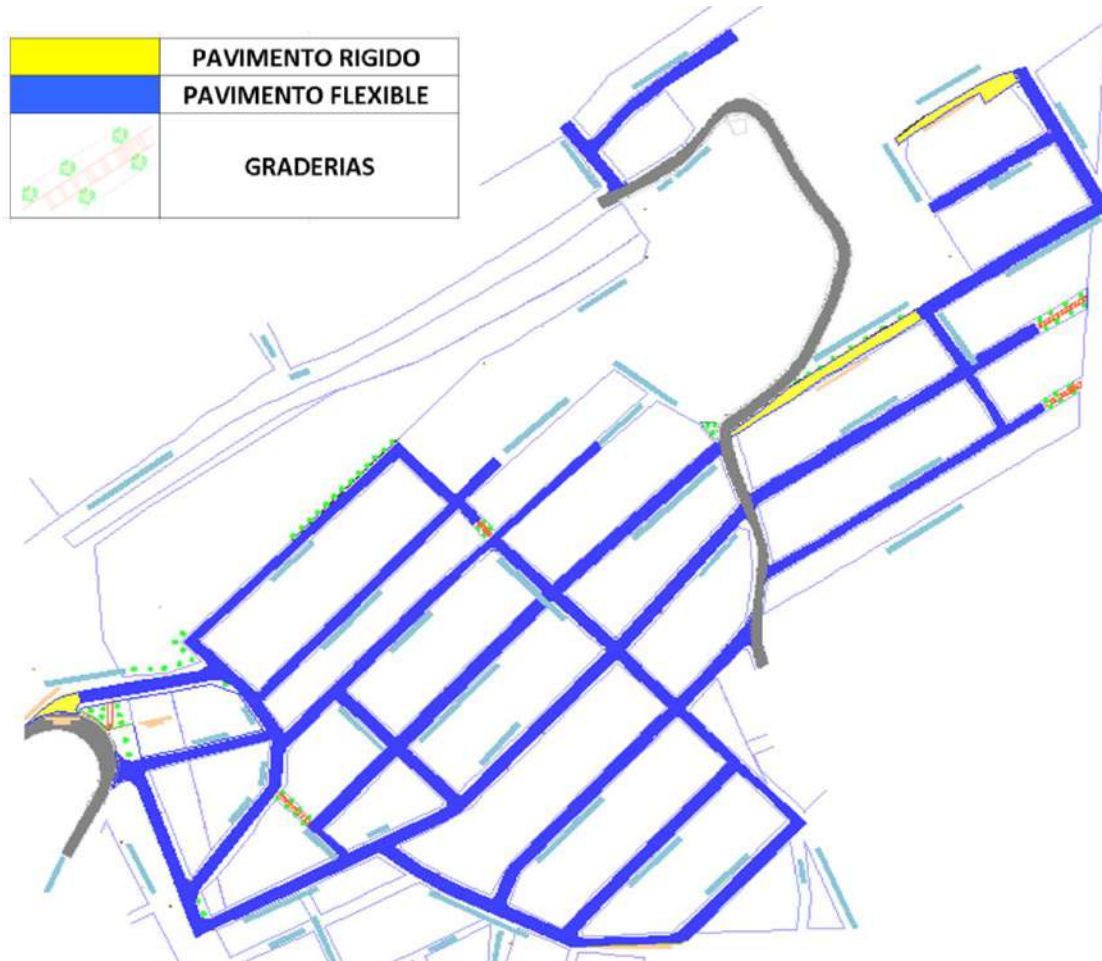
Tipo de pavimentación por calle en zona de proyecto
